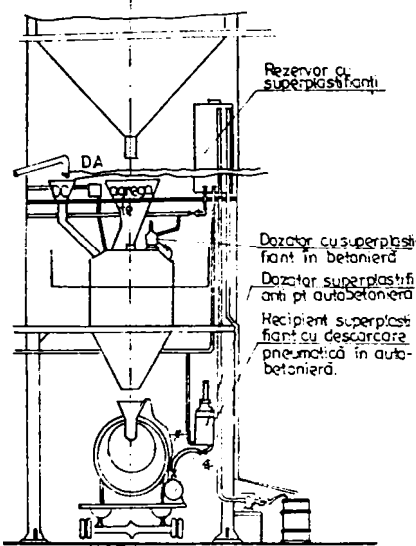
Schema instalațiilor de dozare din stația de betoane și de pe autobetonieră
